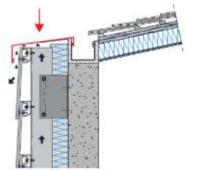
facade ventillé schema de tôle métallique d'acrotère
